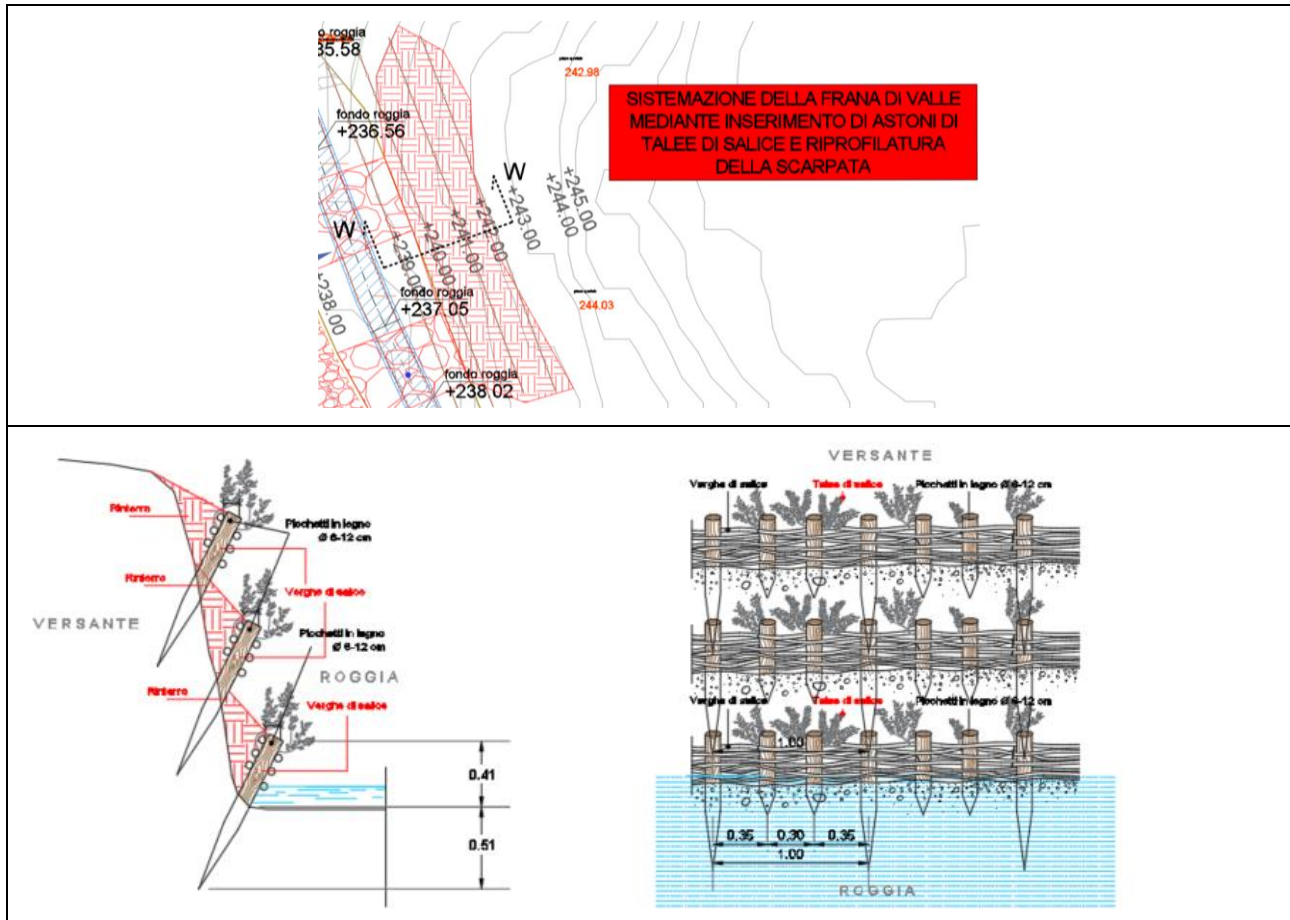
sistemazione della frana di valle: a) stralcio planimetrico; b) sezioni trasversale e frontale
